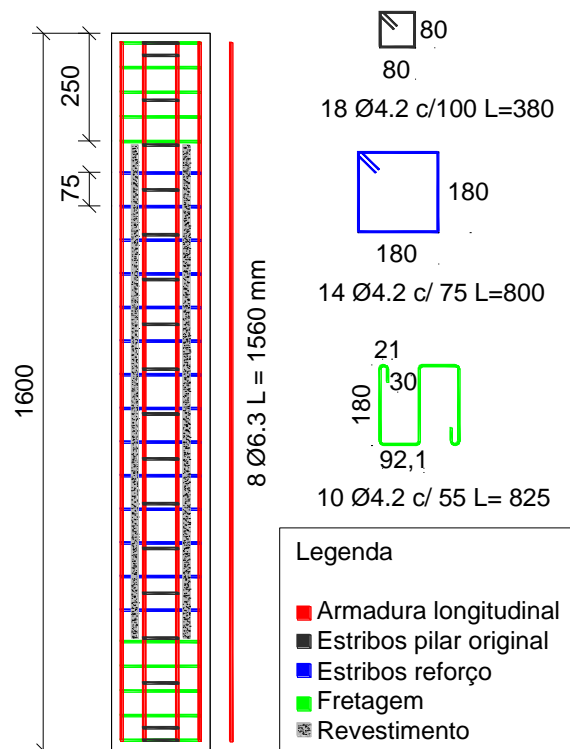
Detalhamento da armadura do pilar PR₇₅
